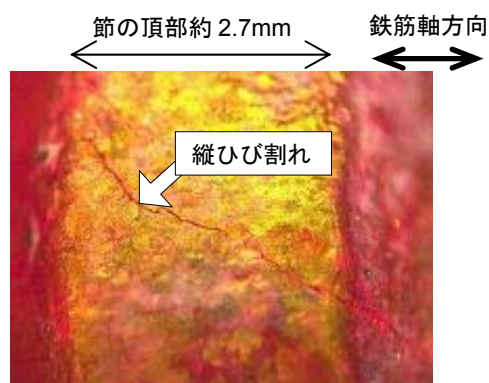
可視化した縦ひび割れ(表面ひび割れ近傍)
